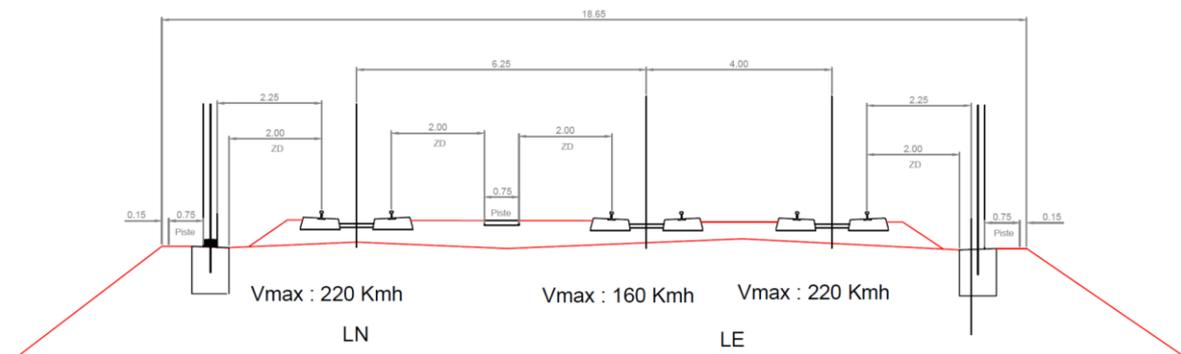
exemple de profil en travers d'une mise à 3 voies
